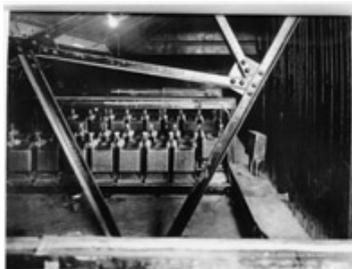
Sala de baterías. Las baterías se encontraban en el ático.
